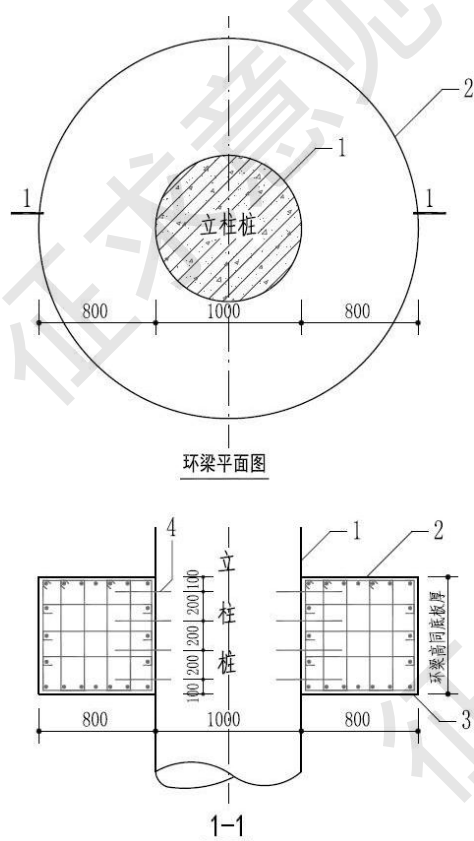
(c) 钢筋混凝土立柱与底板一次性浇筑防水构造
